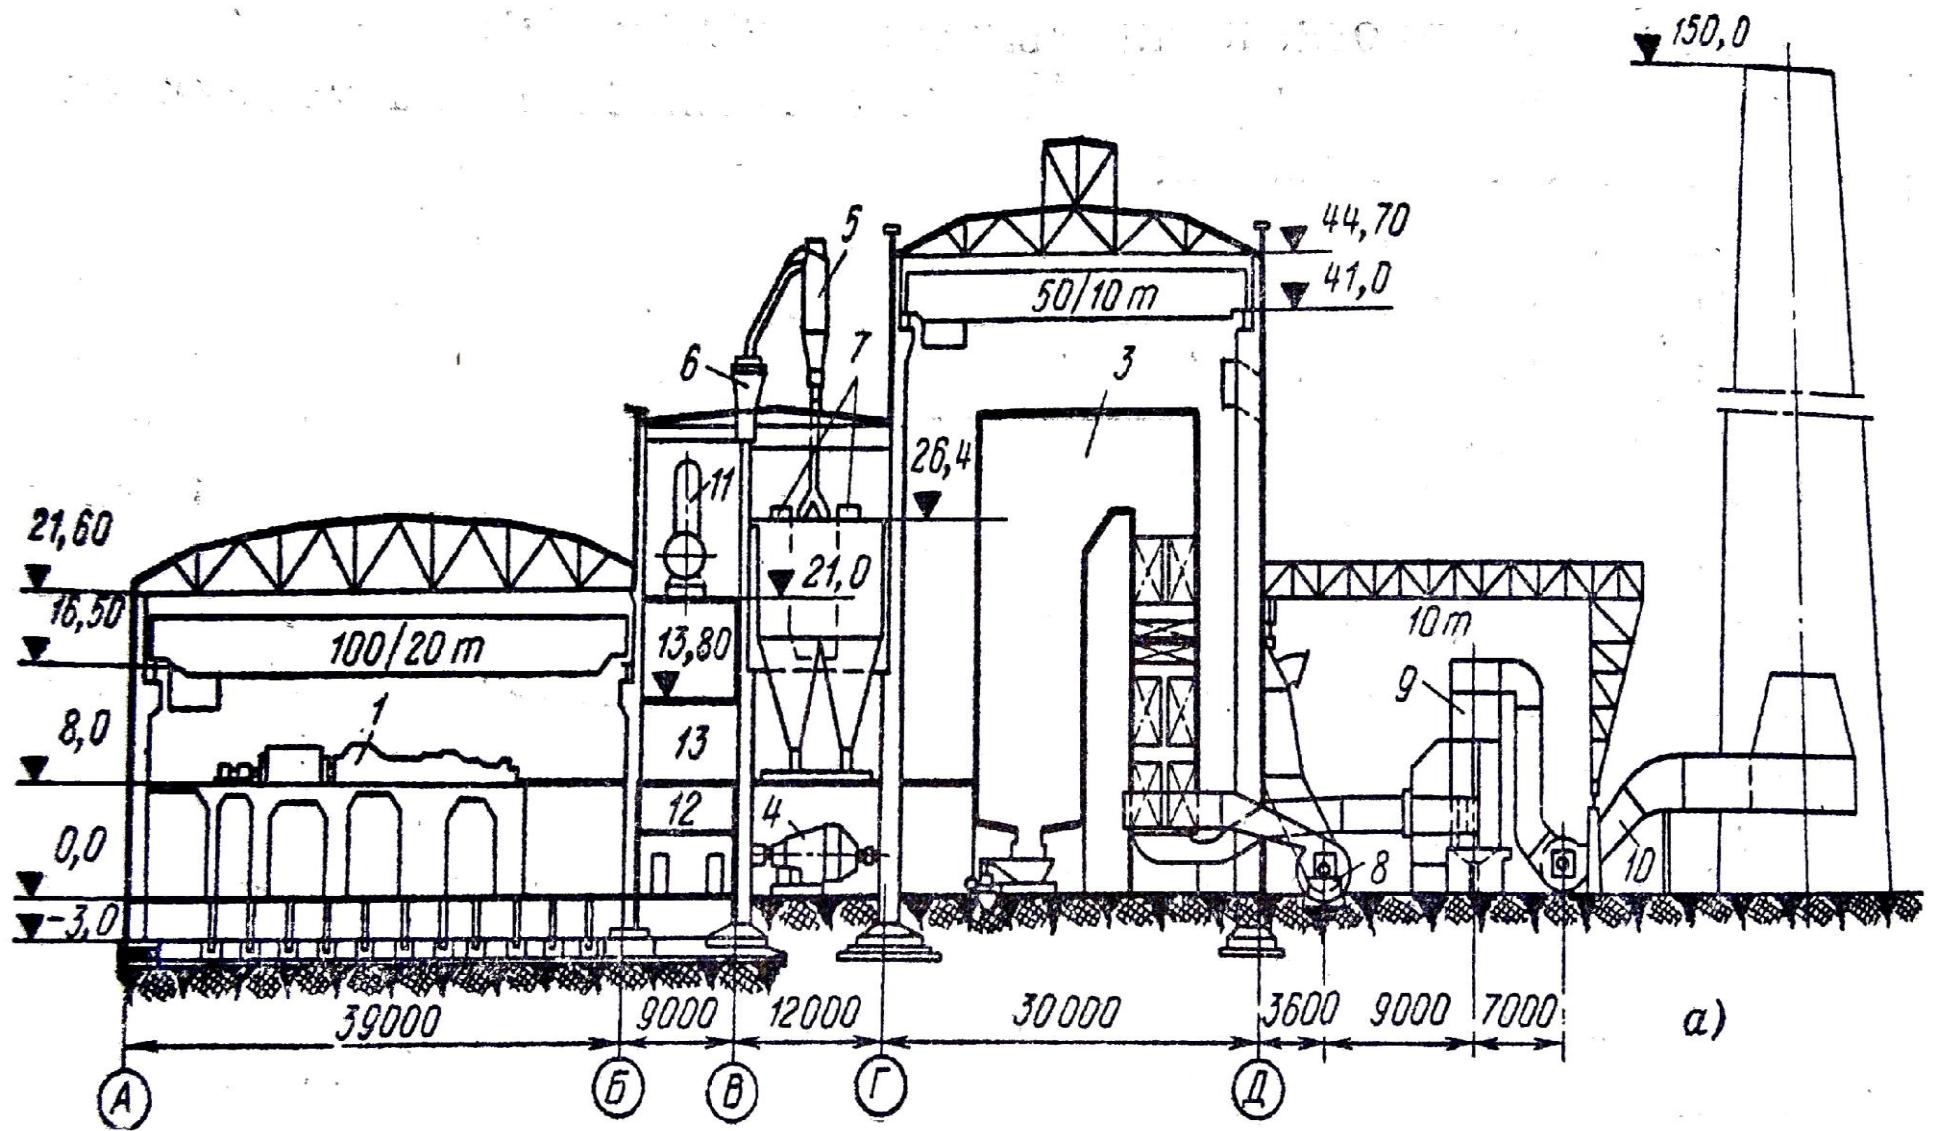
(а) Компоновка главного корпуса пылеугольной ТЭЦ (поперечный разрез)
